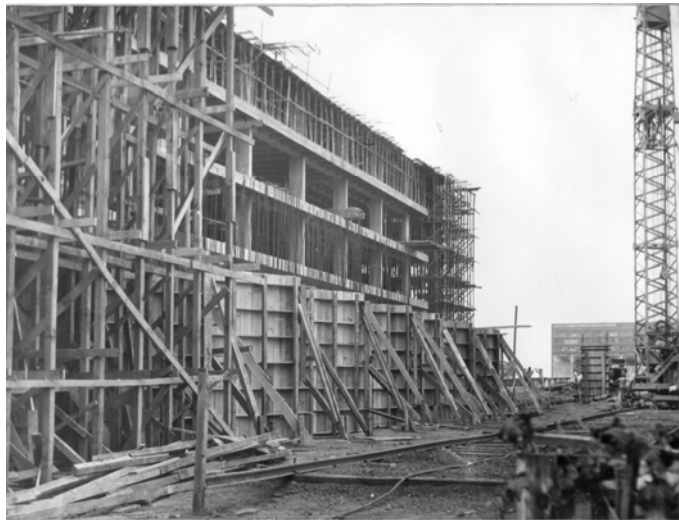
Início das fôrmas do brise-soleil, fachada oeste (Divisão de Obras – MJ)
